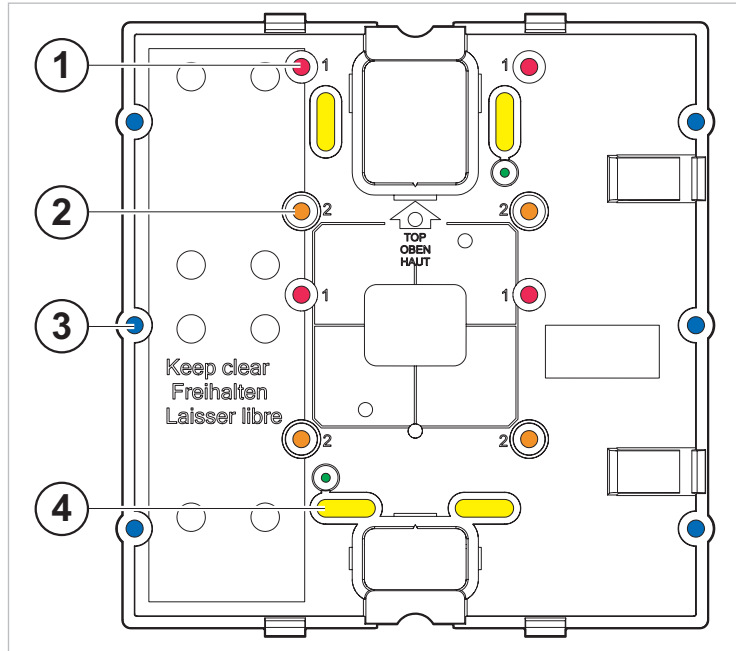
Schraubenlöcher der Universal-Montageplatte
